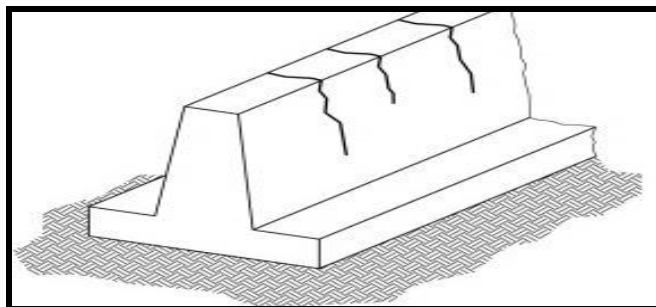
Fissuração típica de retração em muro.
